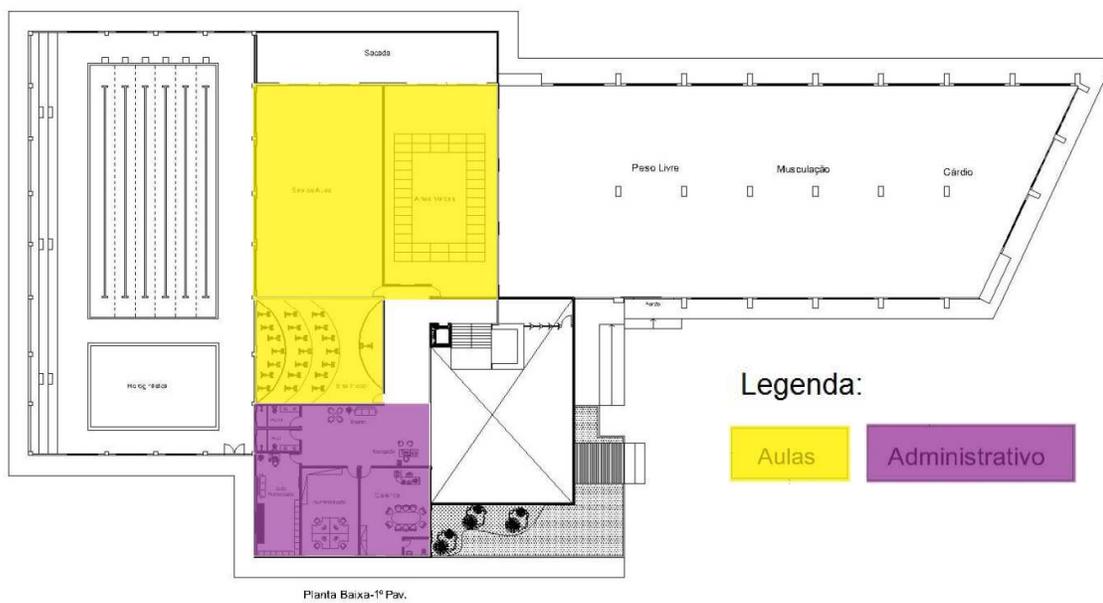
Setorização do Pavimento 01. Fonte: O Autor
